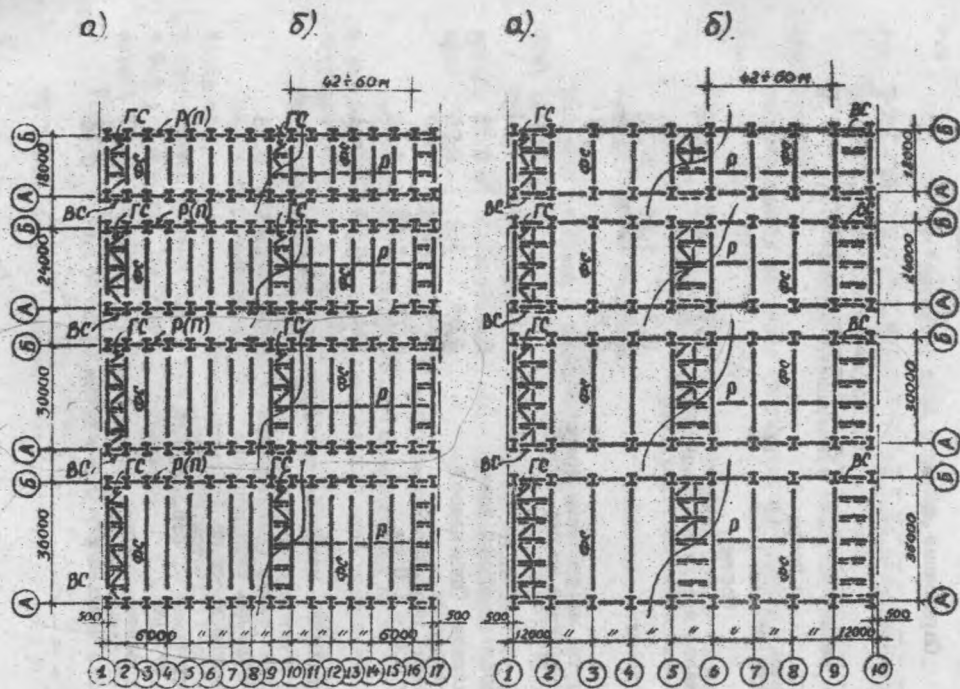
Связи по нижним (а) и по верхним (б) поясам ферм при шаге колонн 6 м
